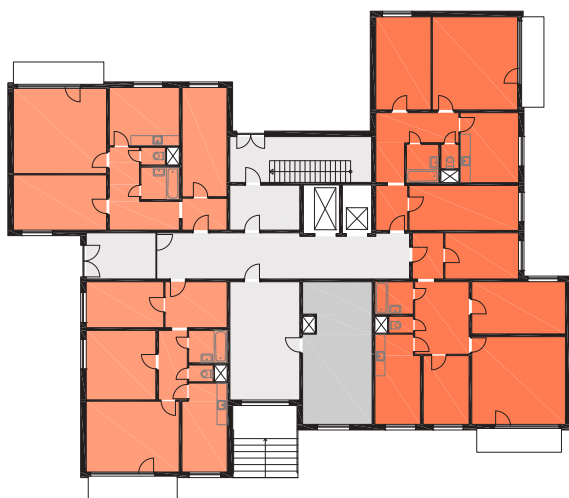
Konstruktivní soustava B70 - Brno Vinohrady (Zdroj: panelaky.info)
